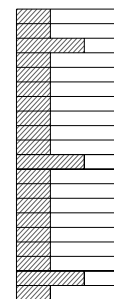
Sección de muro doblado de 1,5 pies de espesor.
